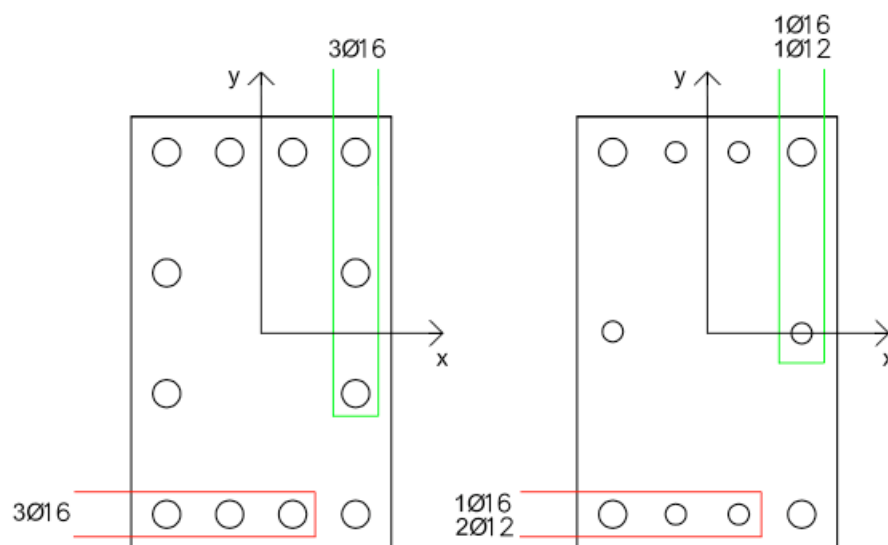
Exemplo de armaduras para Pilares em flexão desviada.
